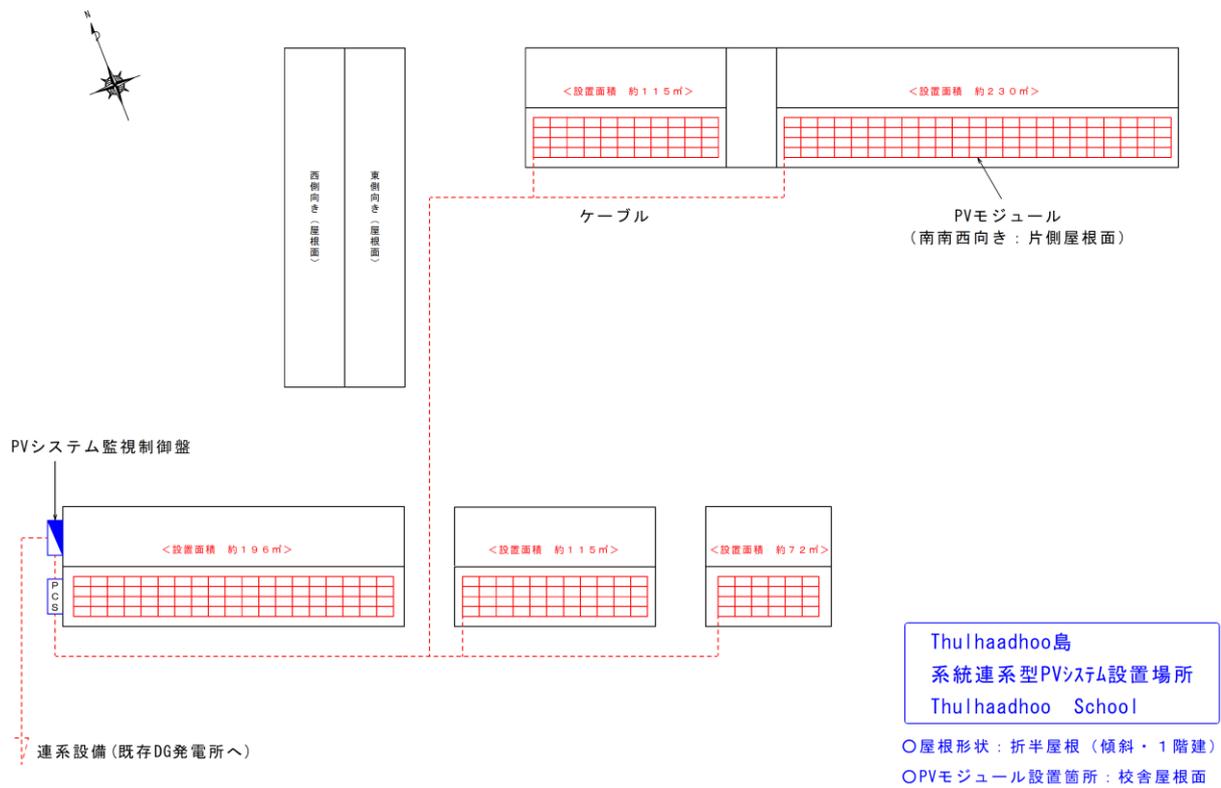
Thulhaadhoo 島の学校建屋の平面図
